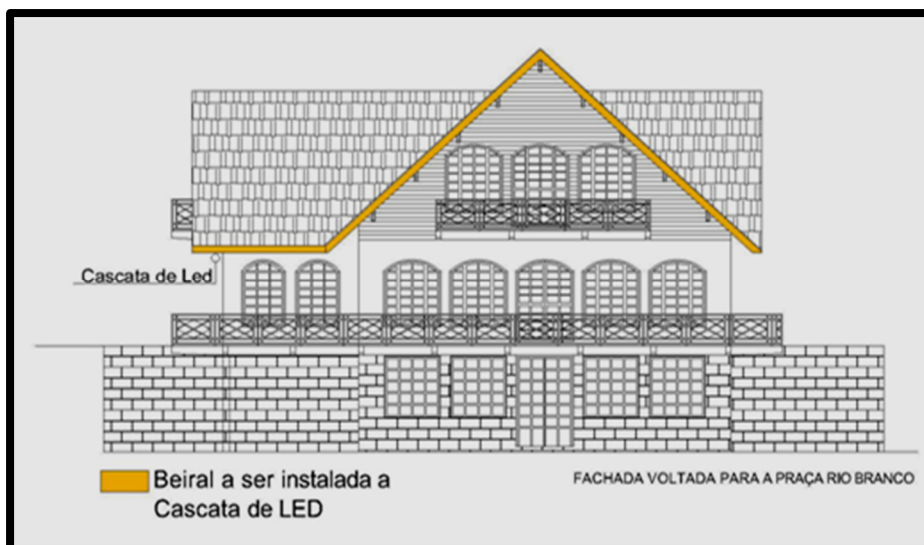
Localização dos beirais de instalação da Cascata de Led, na Fachada para a Rua Praça Rio Branco
